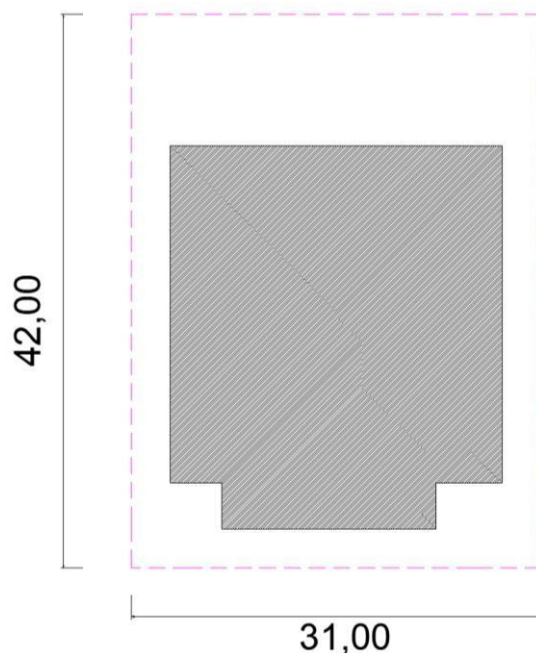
Área destinada ao canteiro de obra, cercada por tapume em telha metálica
